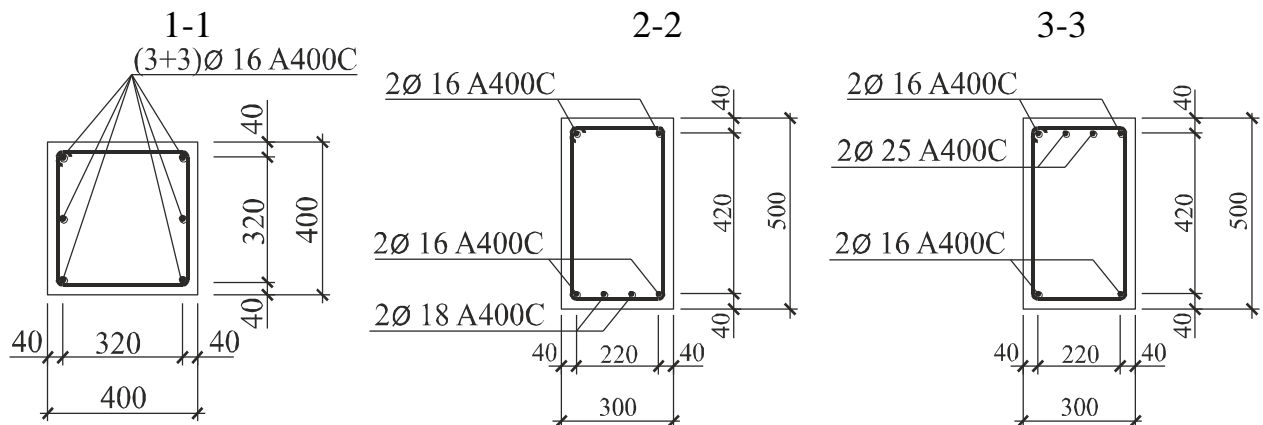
Армування елементів залізобетонного рамного каркасу:
